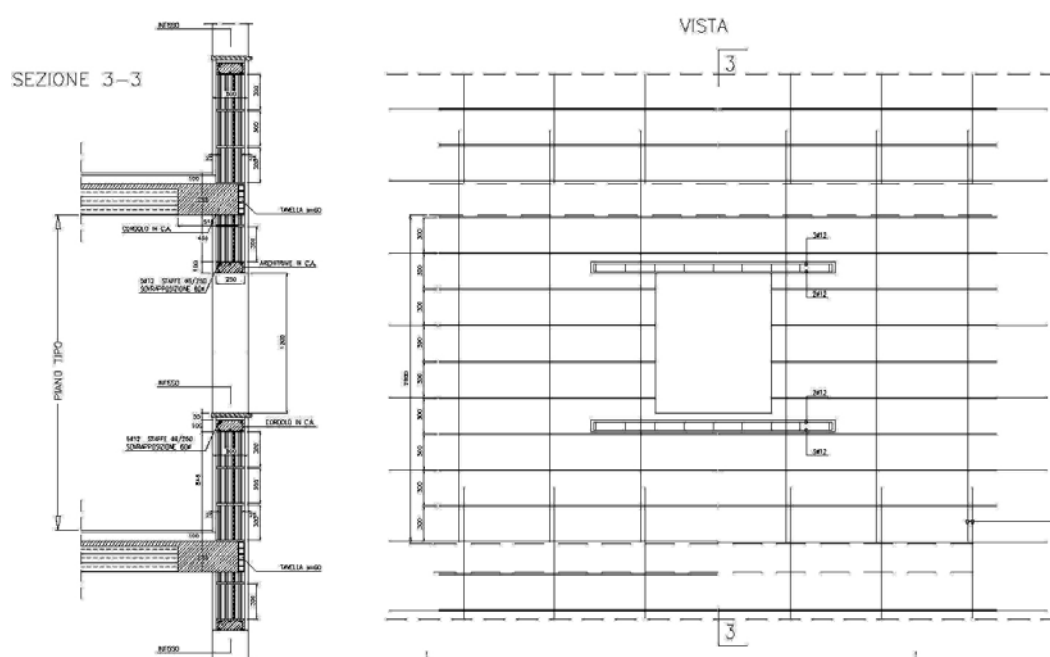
a – Dettagli della parete di muratura armata: sezione e vista frontale.
